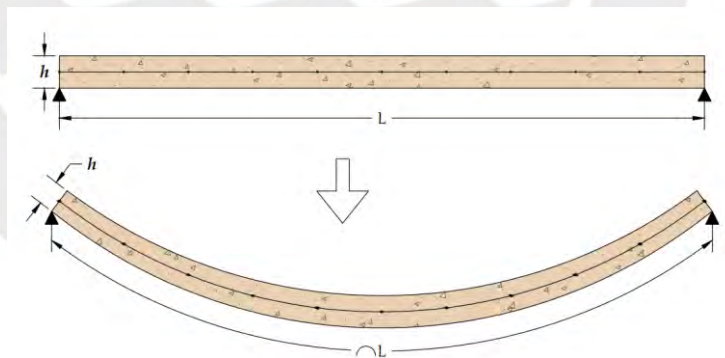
Esquema de deformaciones de losa de concreto armado.
